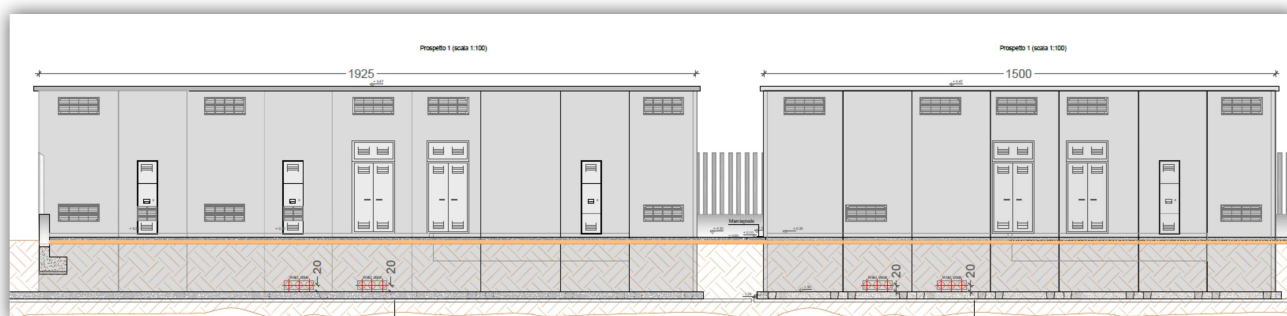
Prospetto dell'assieme dei nuovi edifici tecnici.
